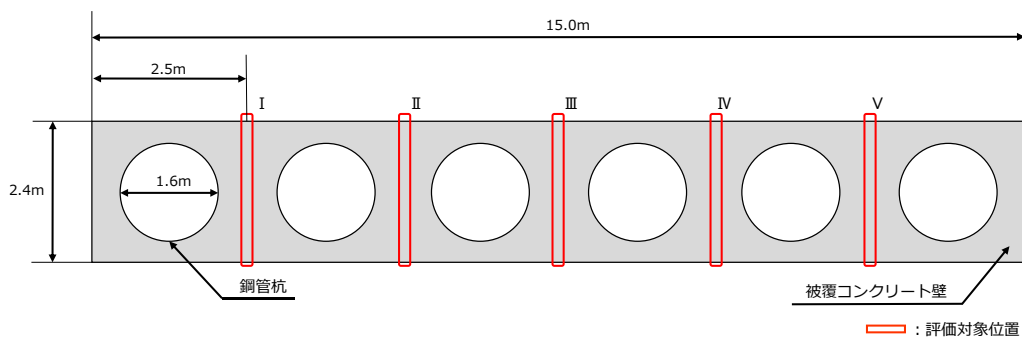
(1) 評価対象位置図(②-②断面, 平面図)
